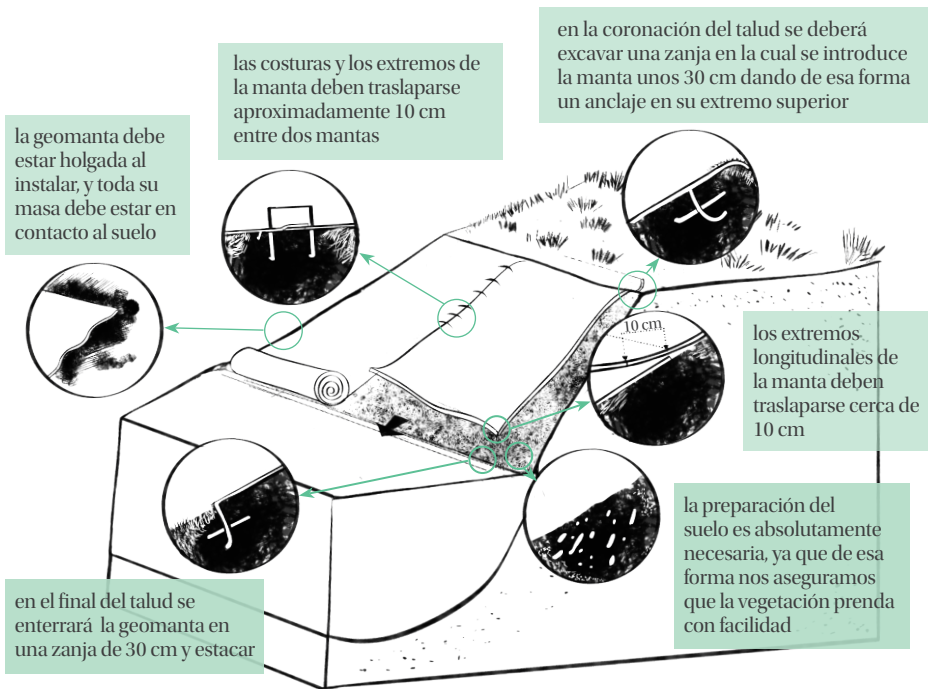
Pasos para posicionar la manta junto con la vista panorámica de la cobertura con manta para el control de erosión.
